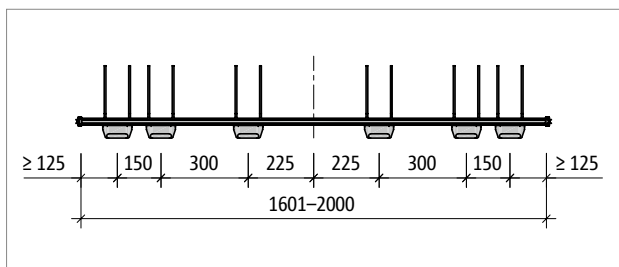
Schöck Tronsole® typ T-V4...-L1601 až L2000: Půdorys prvku
